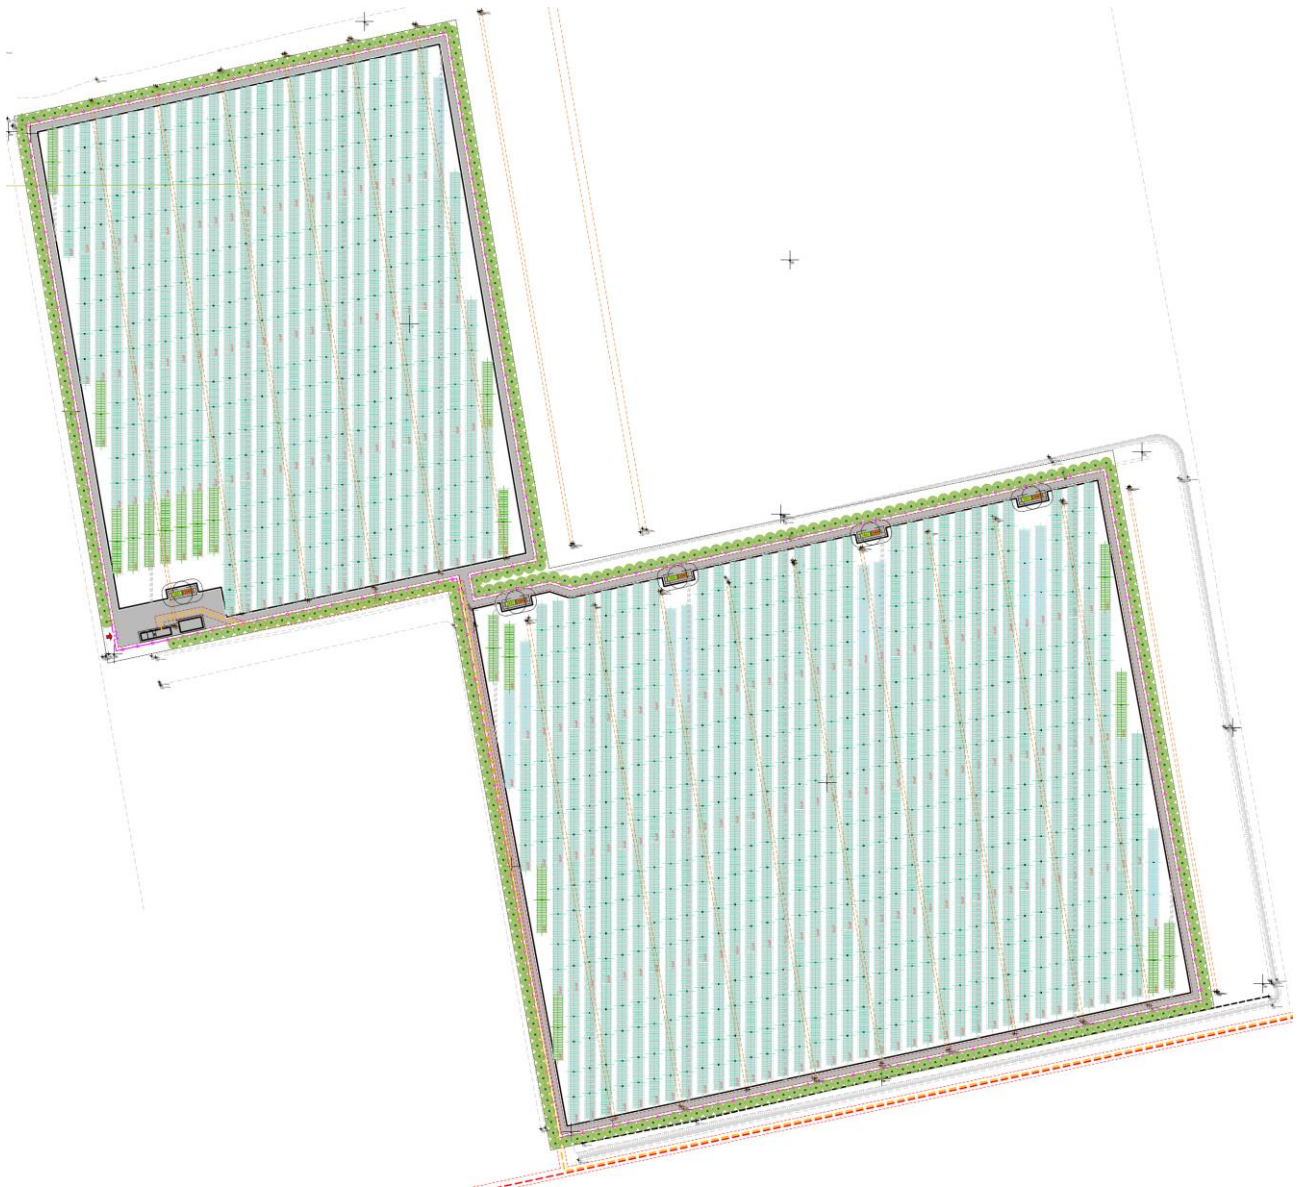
Layout impianto FV - Sito "Sant'Anna"
